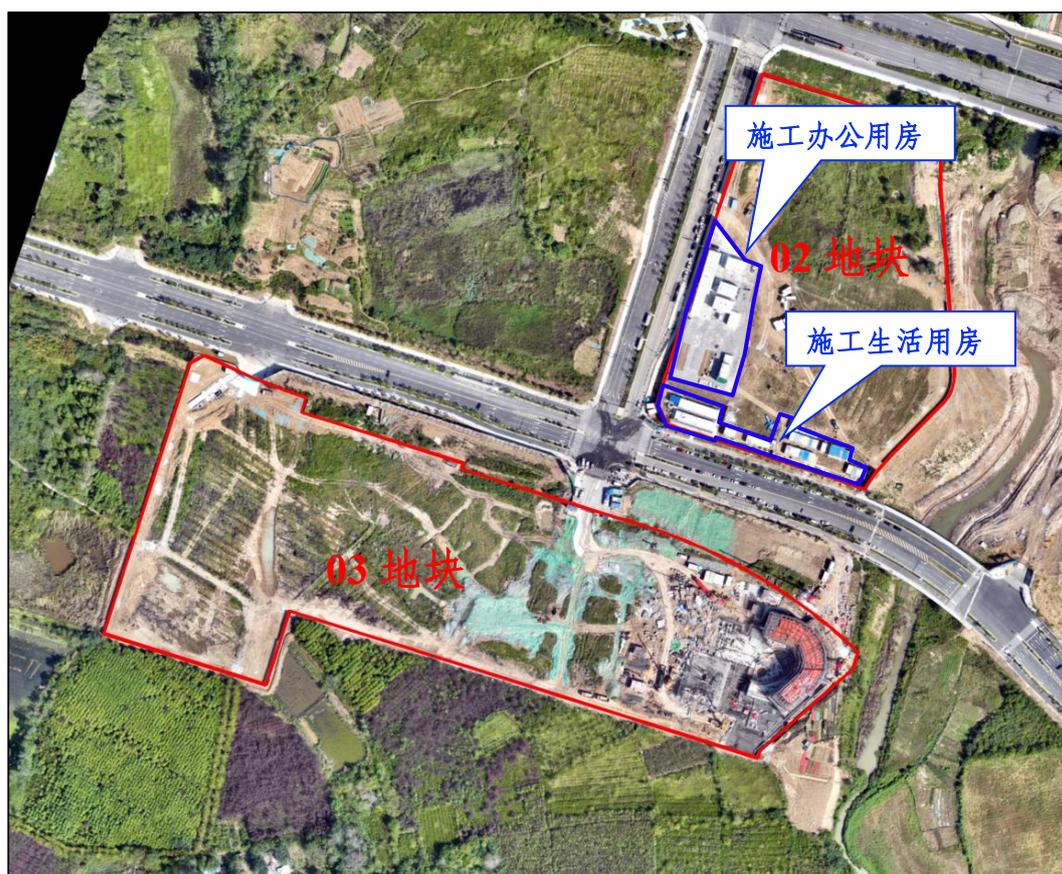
施工办公生活区现状布置图（正射套红线）
